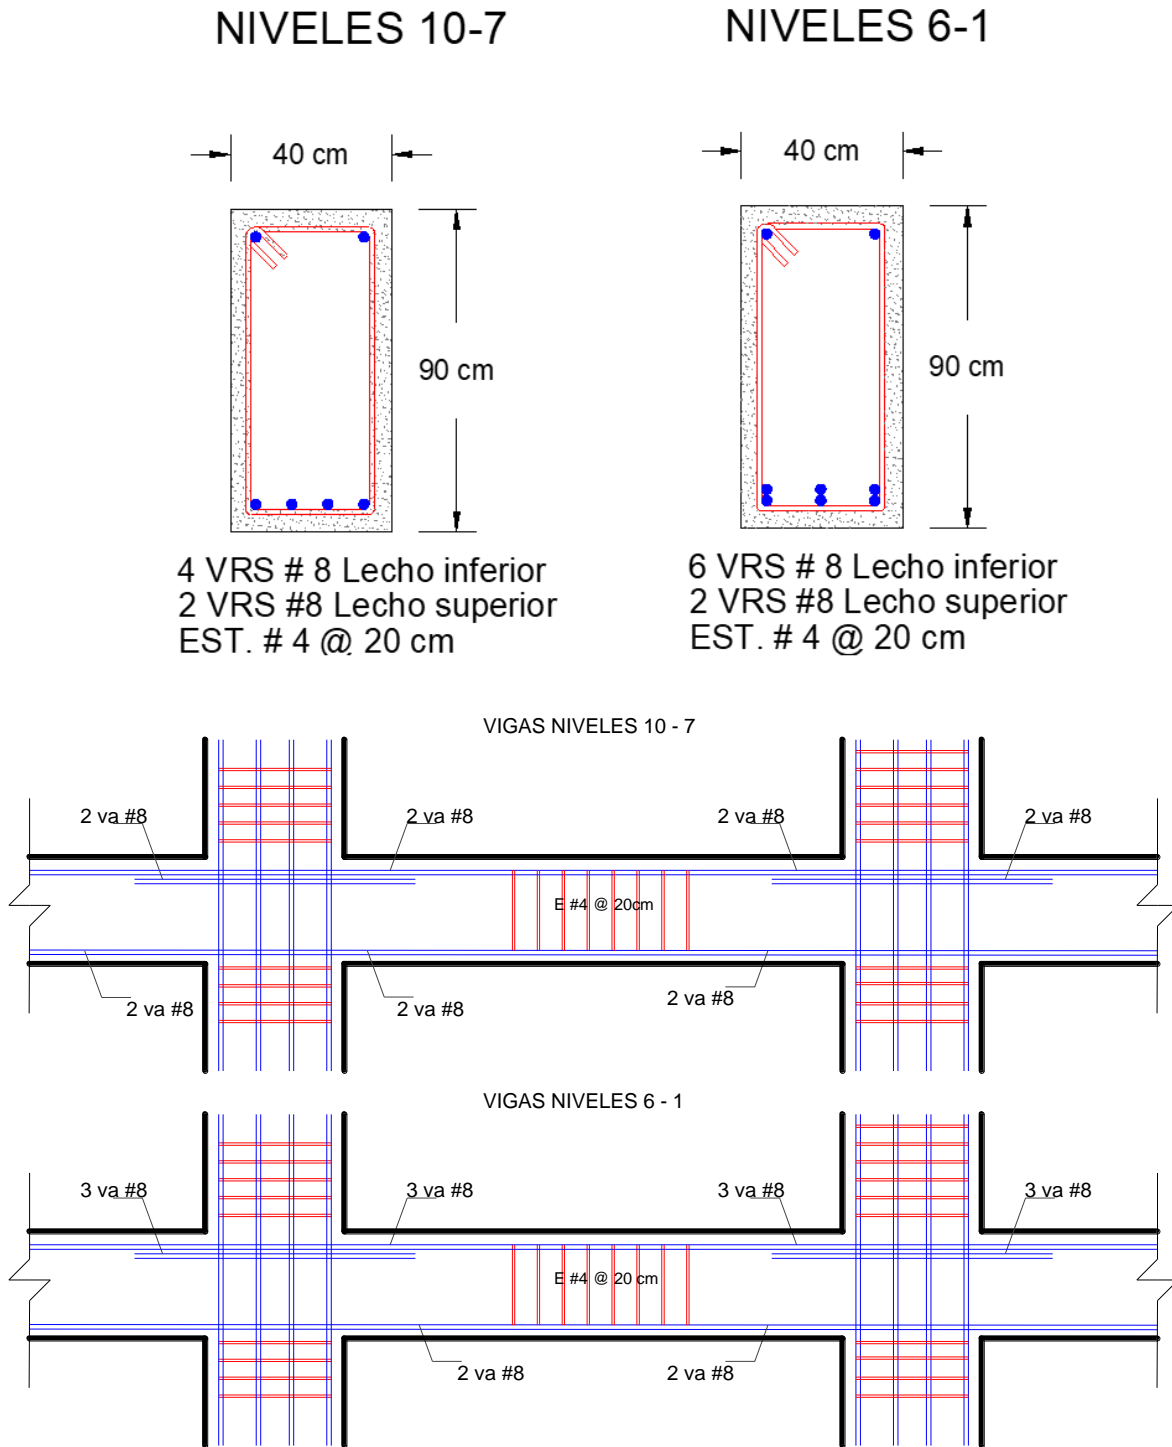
Detallado del refuerzo en vigas para el sistema de marcos
